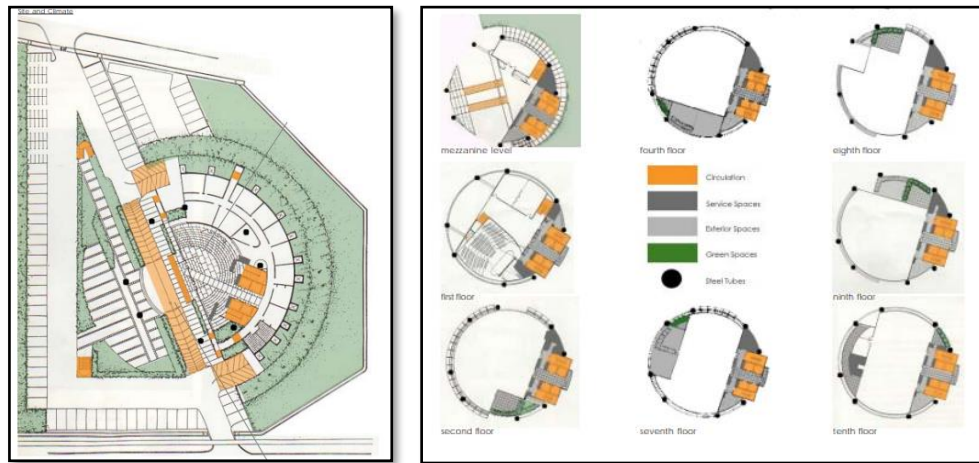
Bentuk Bangunan, Lansekap Dan Balkon
